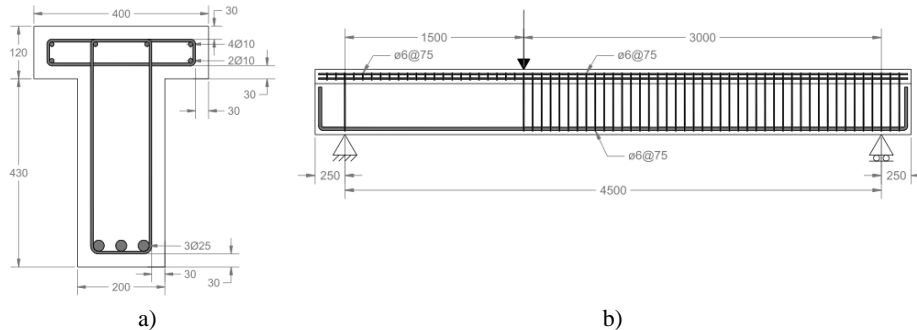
Geometria da viga: a) Seção transversal, e b) vista lateral (dimensões em mm).
